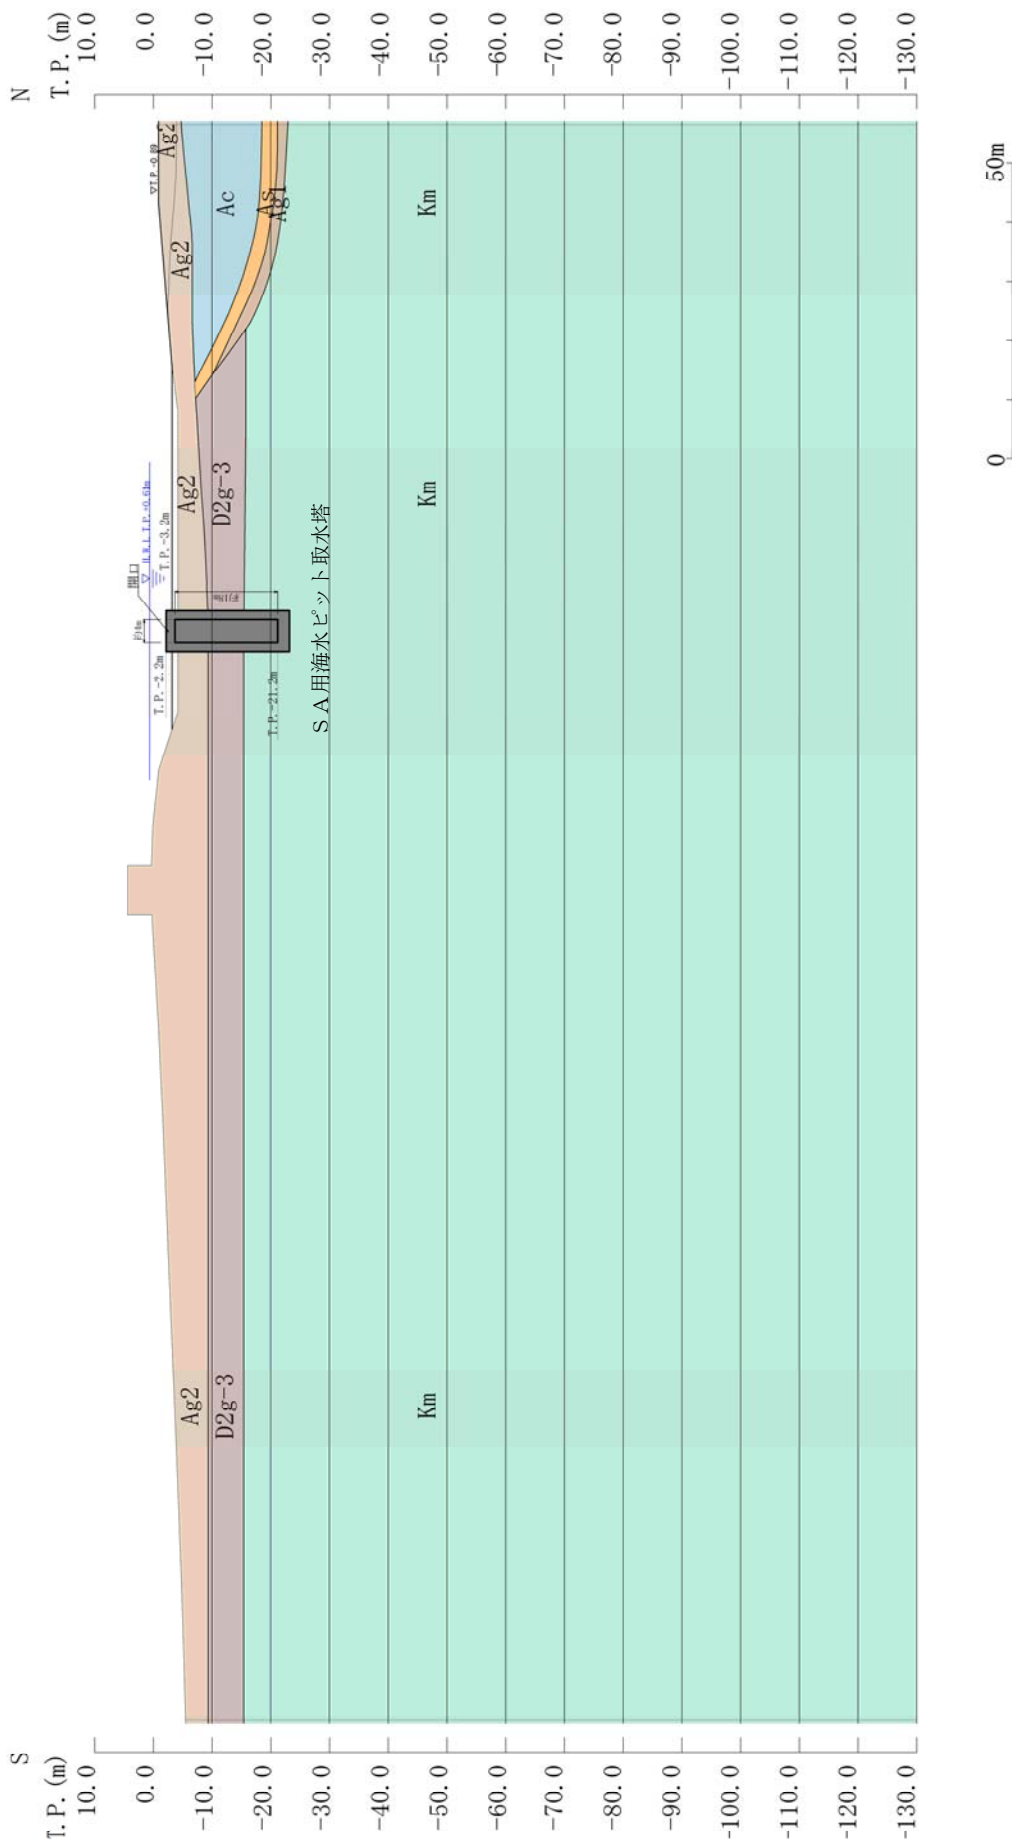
(2) SA用海水ビット取水塔 評価対象断面図 (②-②断面)
